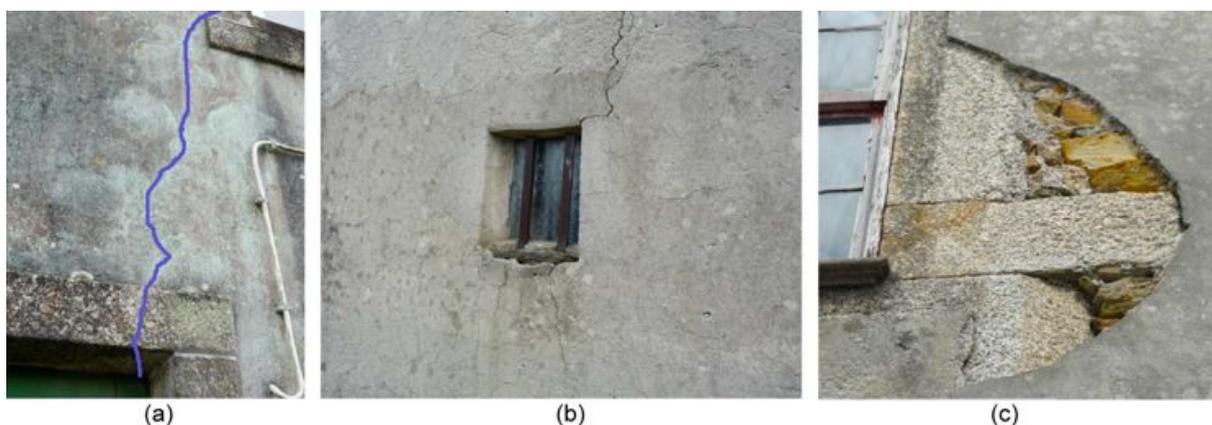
(a) Fenda provocada por deficiente comportamento estrutural e propagada pelos vãos (LN); (b) Fissurações provocadas por tensões junto ao vão (LN); (c) Reboco fissurado e destacado por incompatibilidade entre materiais e por tensões acumuladas junto ao vão (NE)
